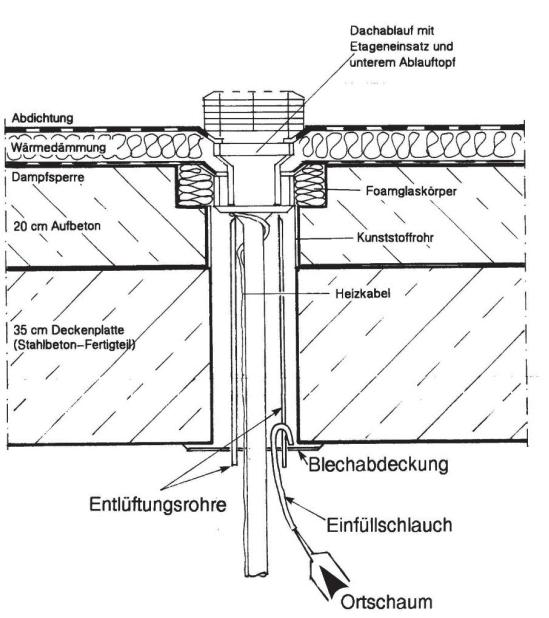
Erst nach Einbau von Entlüftungsröhrchen lässt sich der Hohlraum vollständig ausschäumen.
